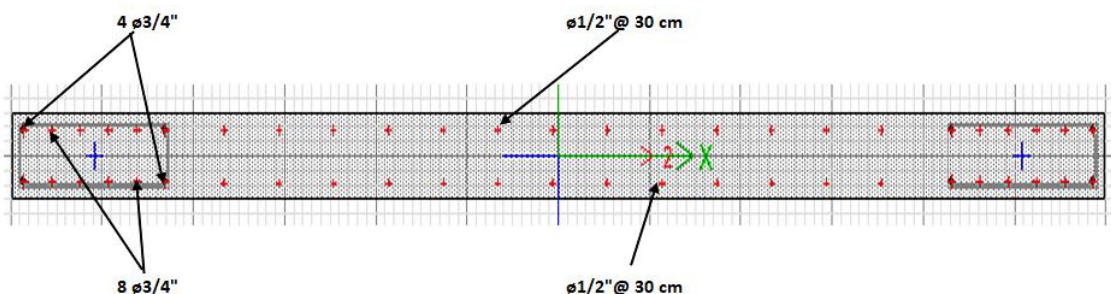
Asignación de acero a los núcleos de borde de la placa, refuerzos horizontal y vertical
